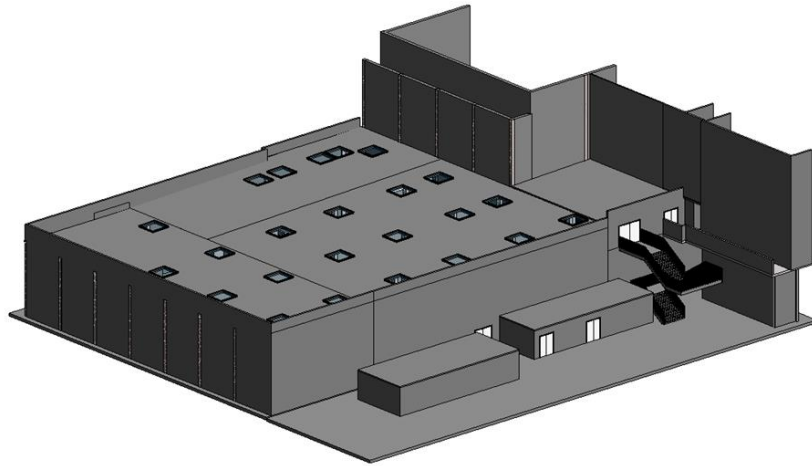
Modelo BIM: plantas *Autocad* (.dwg)
